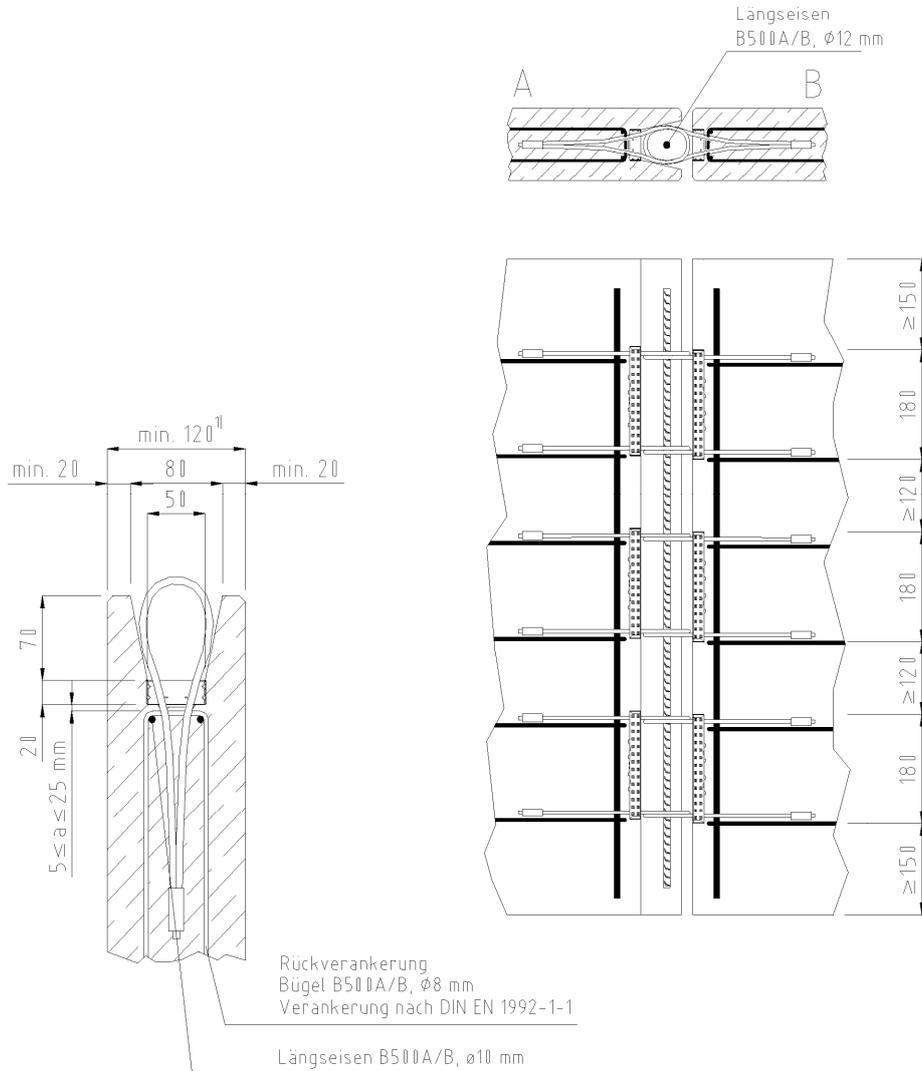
Vergussnut, Bewehrung (Detail Fertigteil A)
